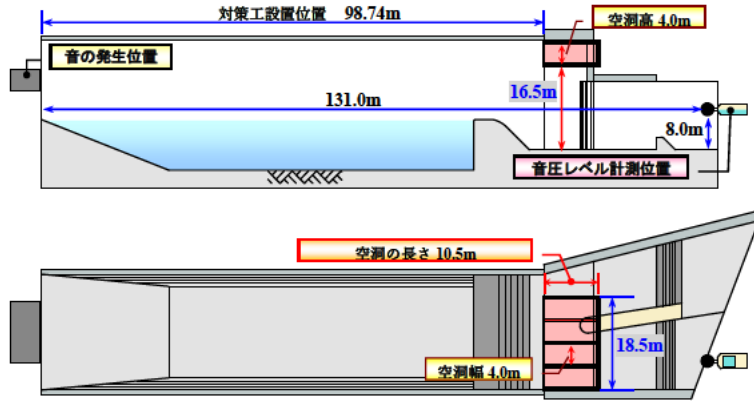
選定された対策工（実験模型）の立面図・平面図
